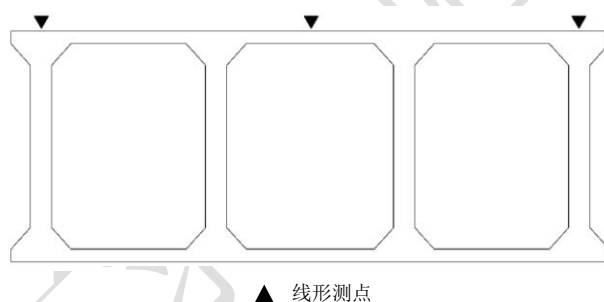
2 混凝土拱圈断面线形测点布置示意图
